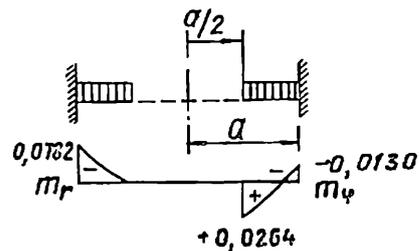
45. Радиальное и кольцевое армирование кольцеобразных плит, защемленных по внешнему контуру
